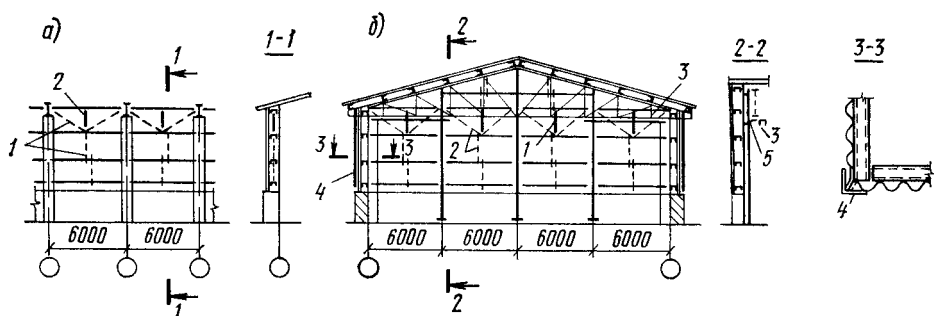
Схемы фахверка наружных стен из волнистых асбестоцементных или металлических листов
